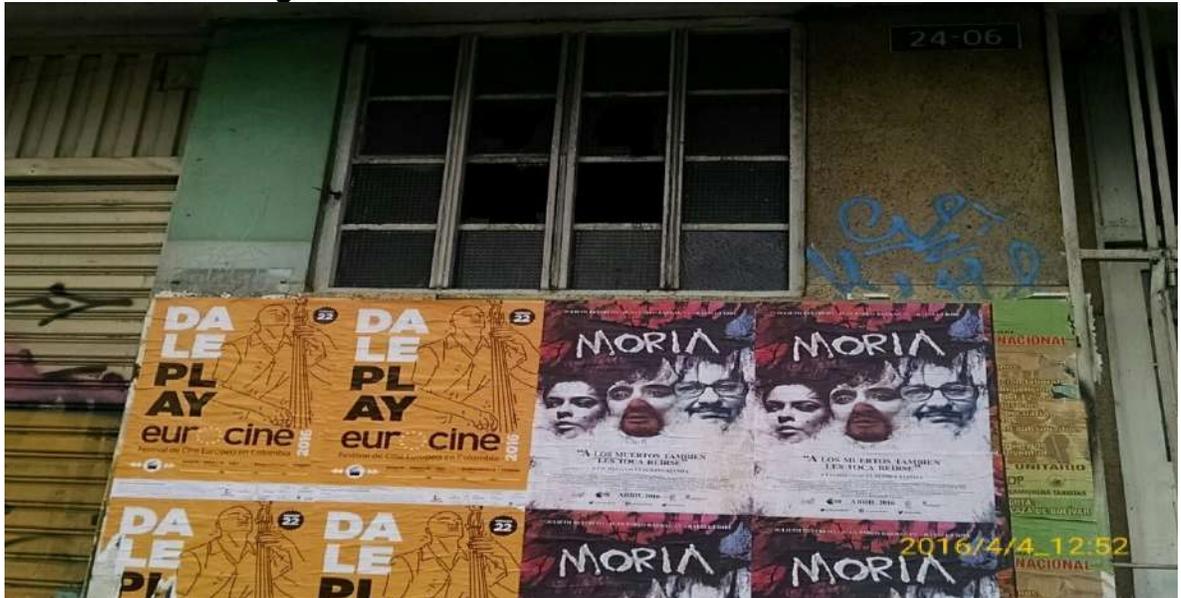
Fachada de la Av. Caracas No. 22-84
